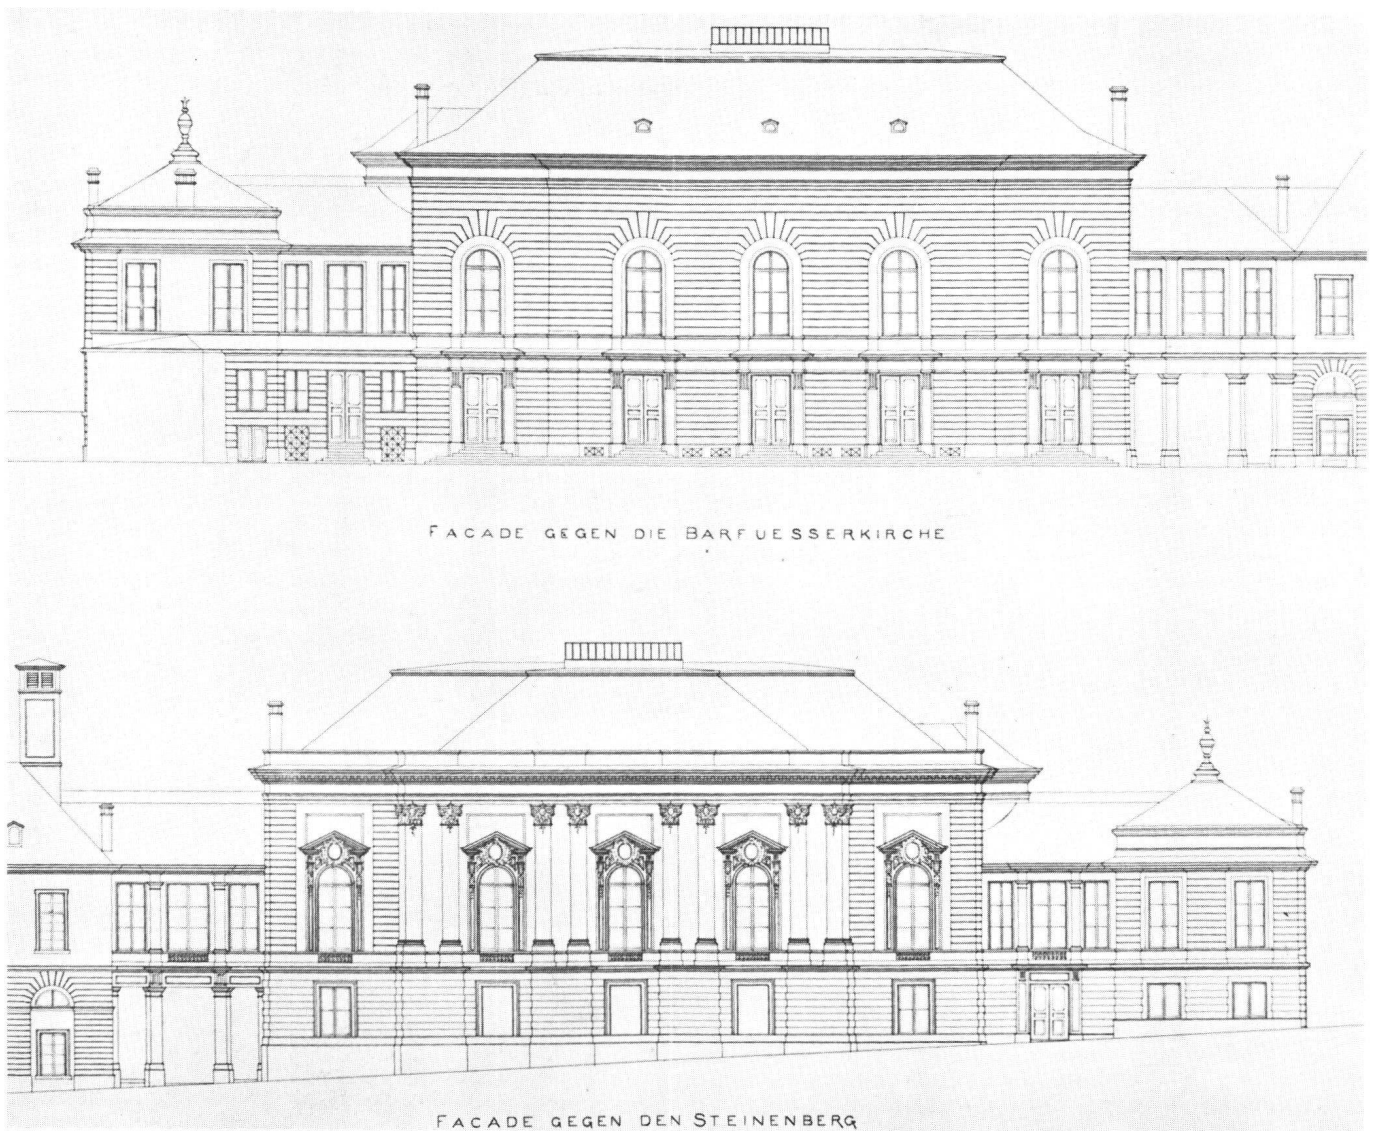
J. J. Stehlin d. J., Aufriss der Nordfassade mit einstöckigem Garderobentrakt (ausgeführt 1894) und Anbau im Osten (ausgeführt 1904/1905). Aufriss der Hauptfassade mit Anbau im Osten, 1891. Stehlin-Archiv.
